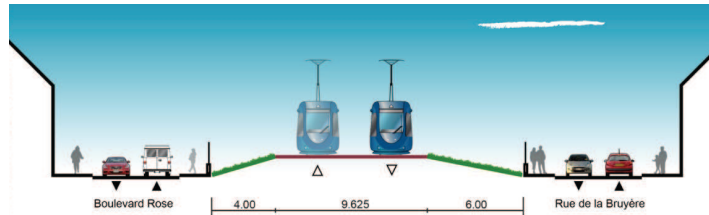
Principe de profil en travers sur le RFN – au nord de la station Poissy GC
